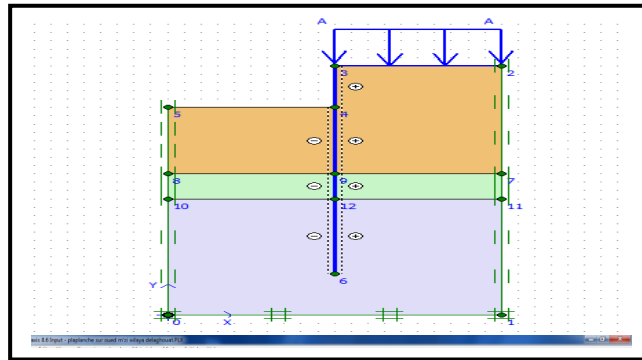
Dimensions géométriques du modèle (30x20) m.
